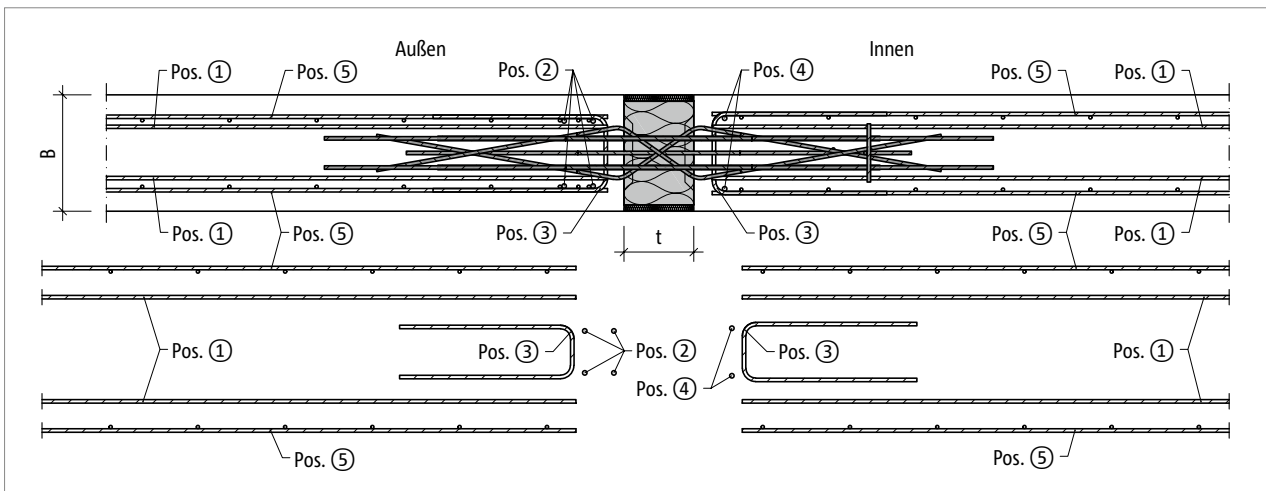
Schöck Isokorb® XT Typ WL: Bauseitige Bewehrung; Grundriss
